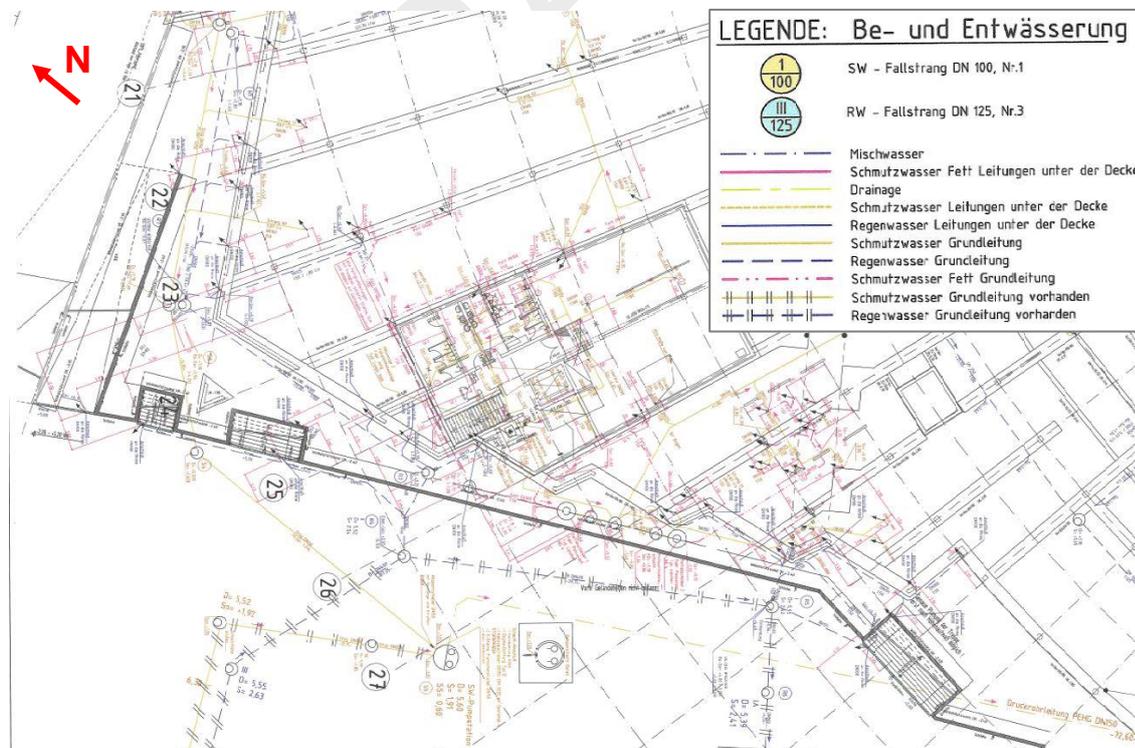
Bestehendes Leitungssystem Fundamentplan Südteil – Ausschnitt aus dem Plan B-HG-01-03/30 (Stand: 26.06.2001)
